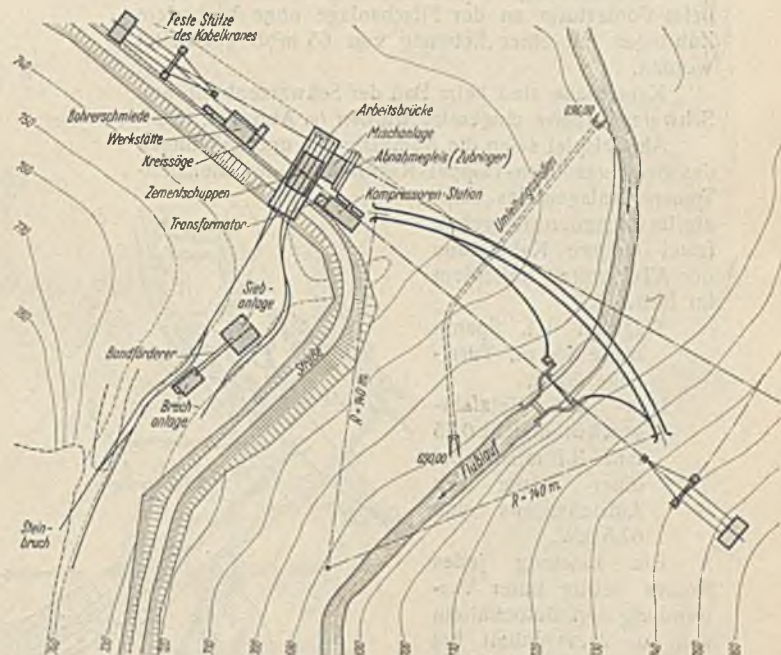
Schwarzasperre. Baustelleneinrichtung. Lageplan.
